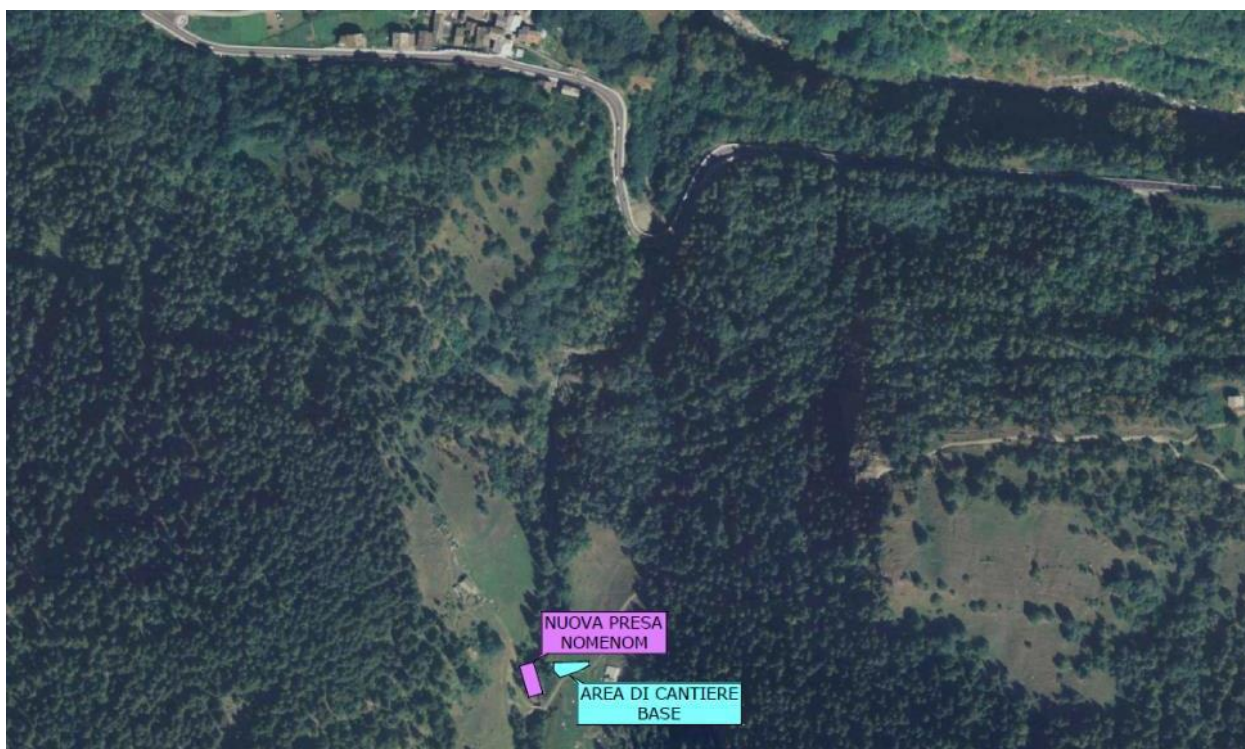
Lotto IV cantiere F realizzazione opera di presa Nomenon e pozzo derivatore
